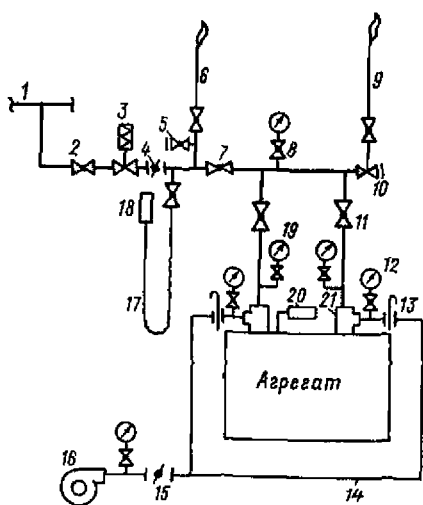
Схема обвязочных газопроводов среднего давления агрегата, оборудованного горелками с принудительной подачей воздуха и отключающими устройствами — кранами.
